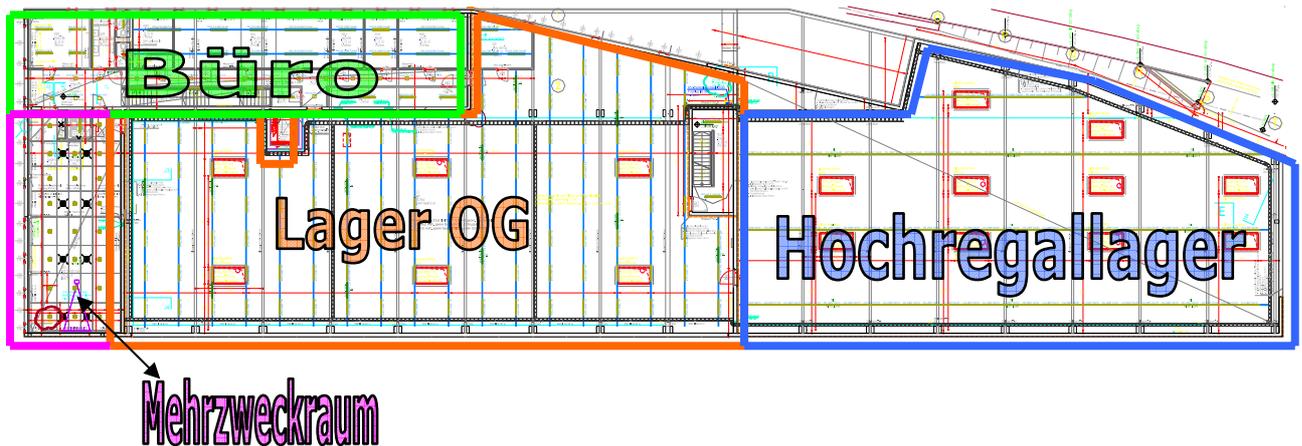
Grundriss OG - Passivbürogebäude und Kommissionierungslager „Eine Welt Handel AG“ [Poppe*Prehal Architekten]
